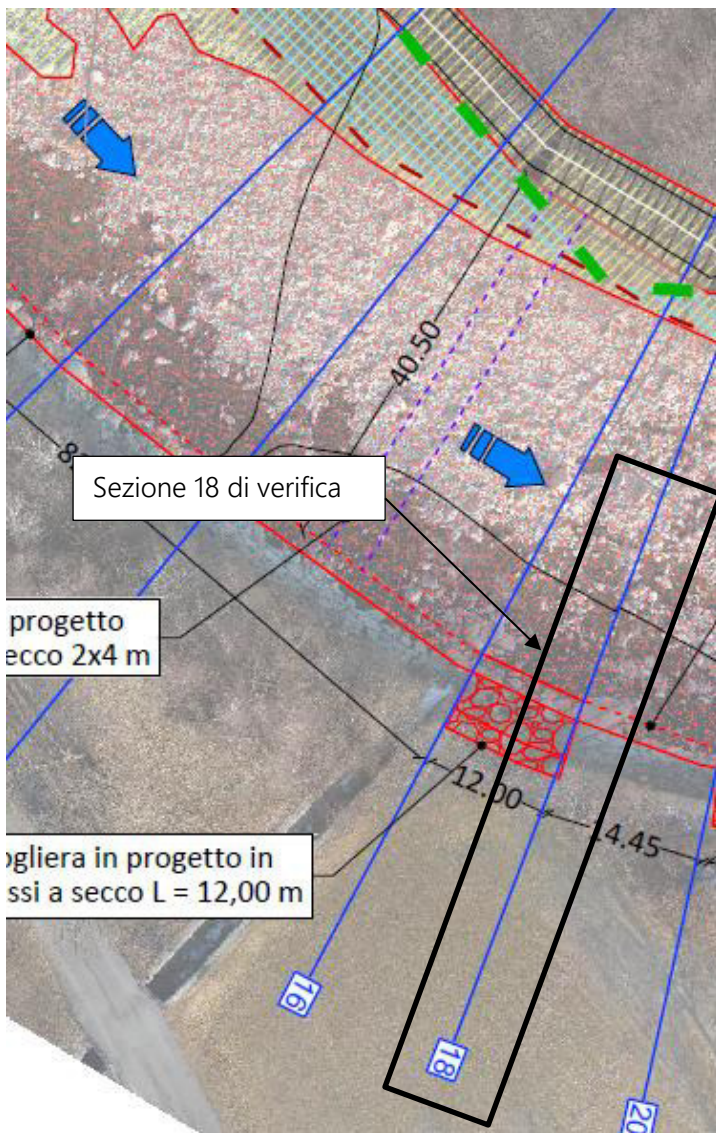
Tav. 03.3_ Planimetria di progetto – Sezione di verifica
